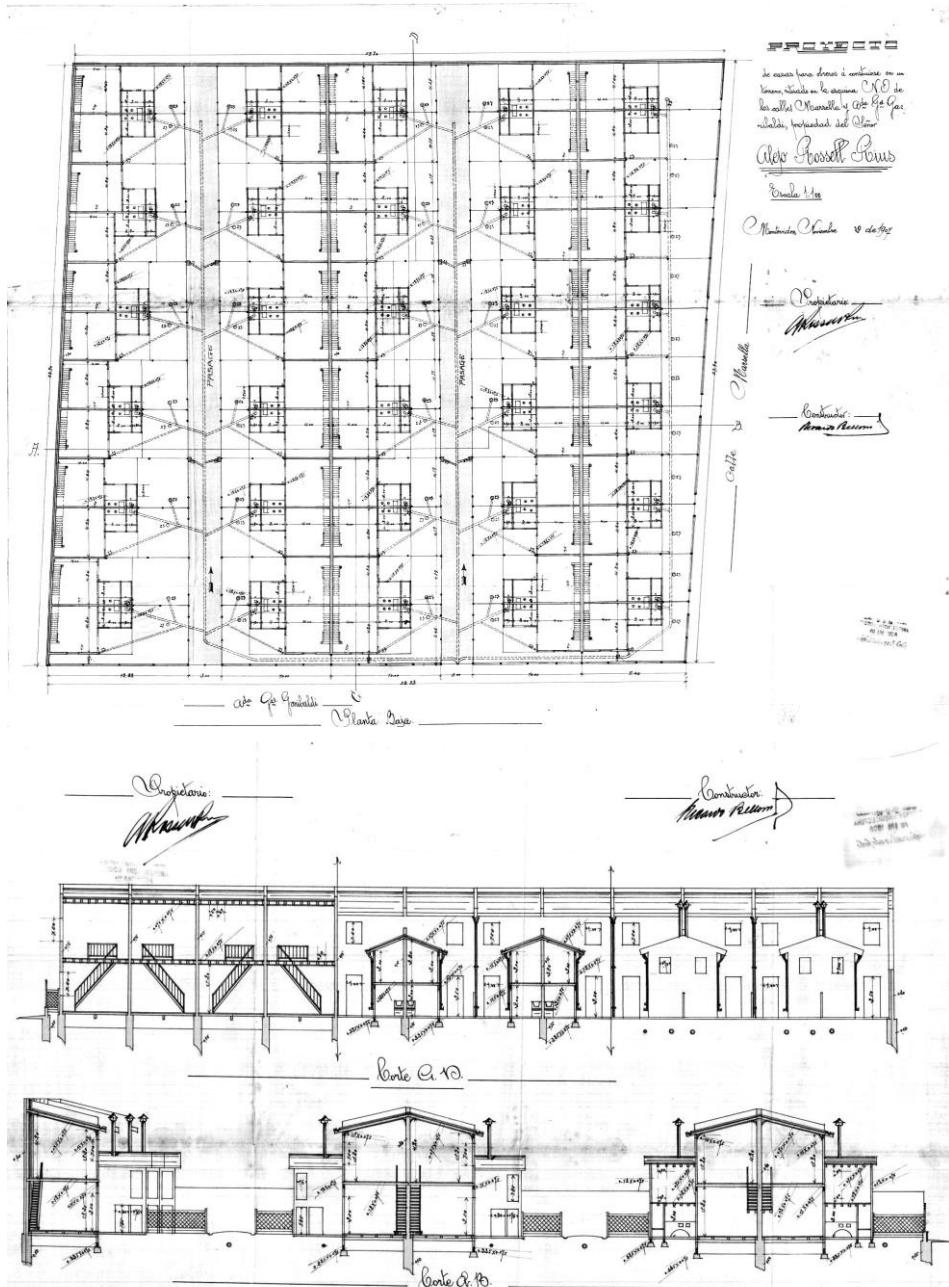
Planta General y alzados de las viviendas Rossell y Rius, 1907.
